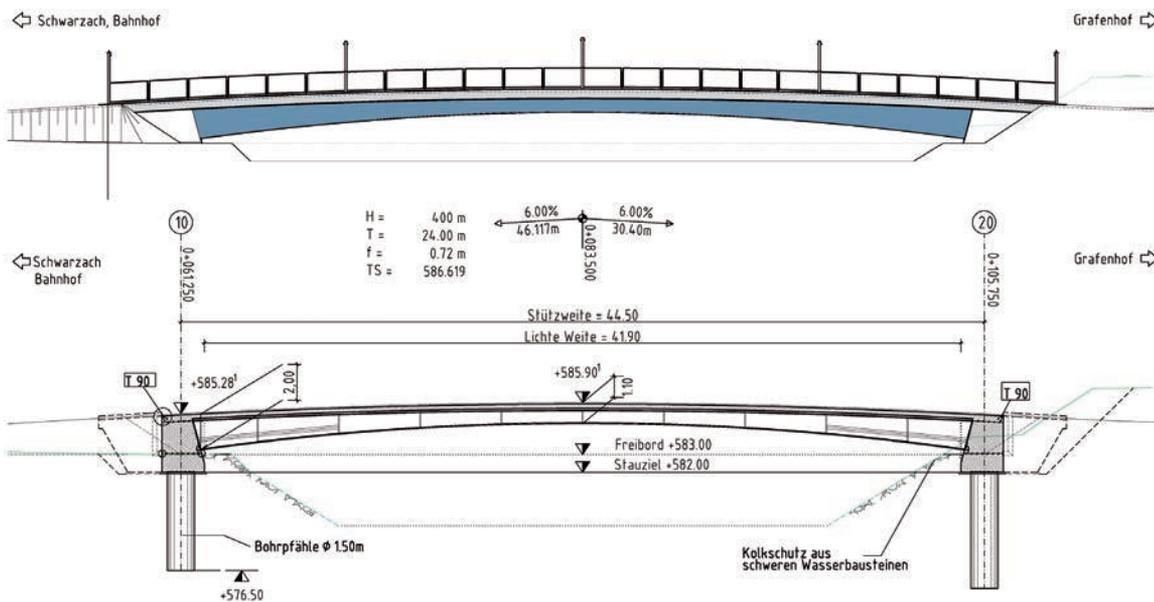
Ansicht und Längsschnitt der Fuß- und Radwegbrücke mit 44,00 m Stützweite (© SSF Ingenieure)
